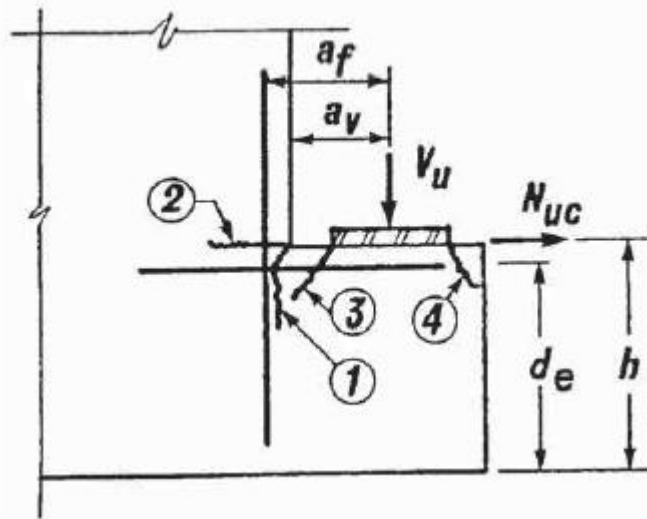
Notación y ubicación de Fisuras potenciales en Vigas Repisa
